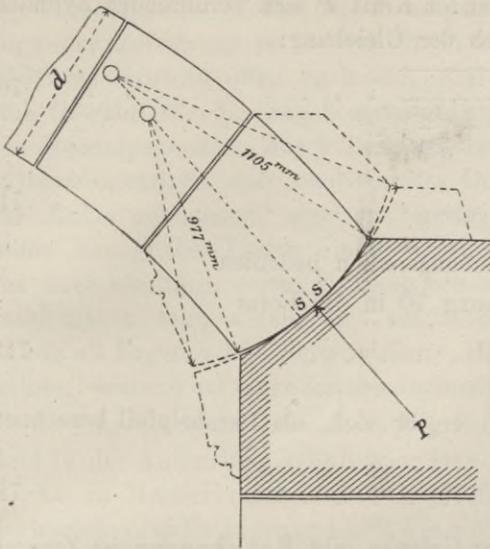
Betongelenk der neuen Eisenbahnbrücke über die Elbe in Dresden.
